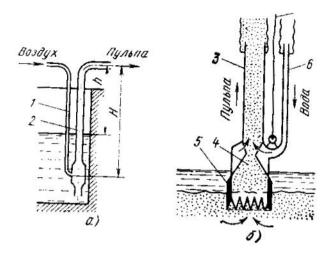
Схемы эрлифта (а) и гидроэлеватора (б)
